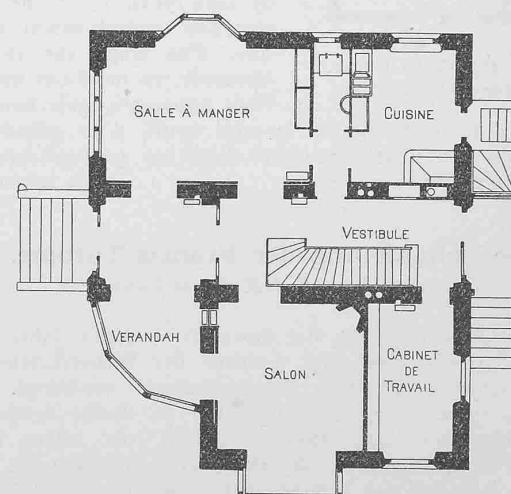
Villa Kummer. — Rez-de-chaussée 1:200.
